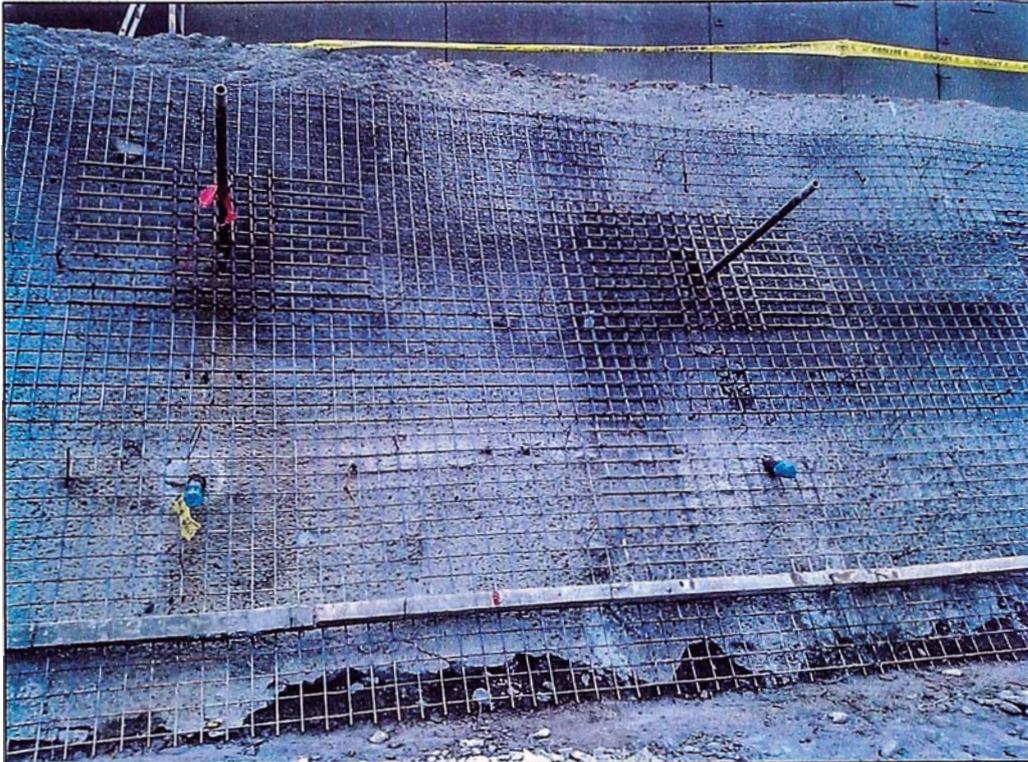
Armado y colocación de la 1ra. malla de refuerzo.
